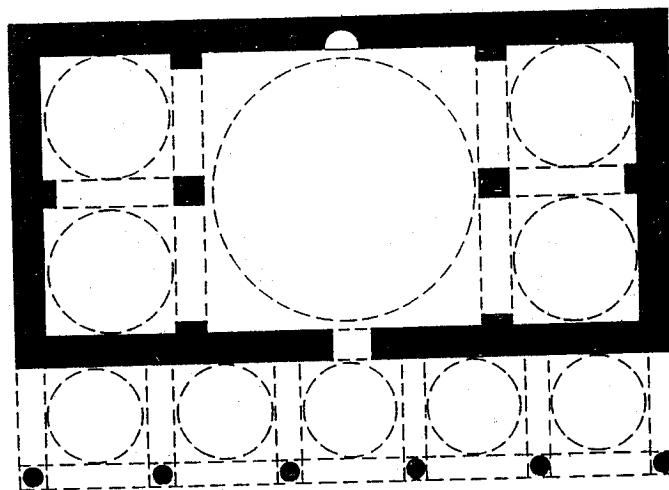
المسقط الأفقي لمسجد الباب المردوم
